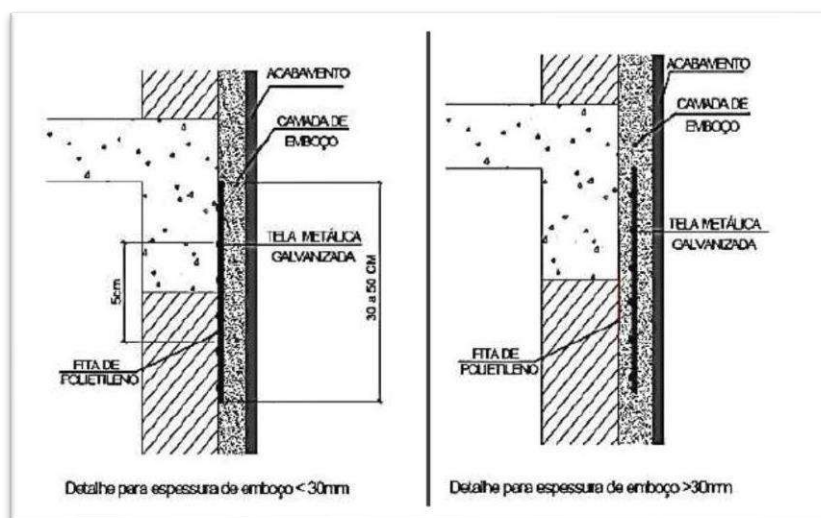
Posicionamento das telas metálica na camada de recuperação.
